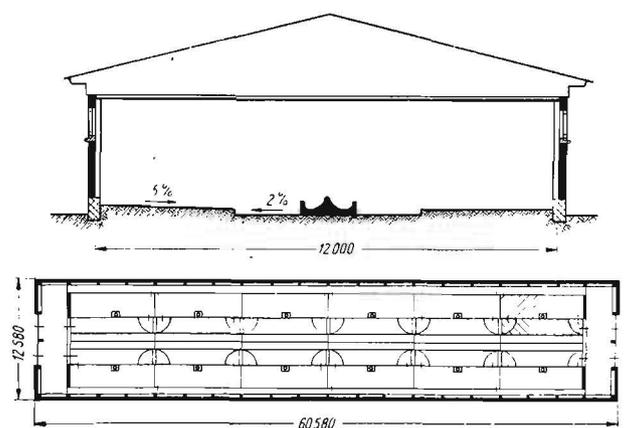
Grundriß und Schnitt eines Schweinemaststalles für 600 Tiere in Großgruppenhaltung
